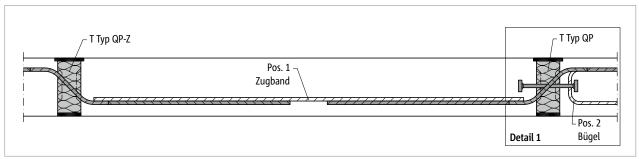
Schöck Isokorb® T Typ QP-Z, QP: Schnitt A-A; Bewehrungsanschluss Zugband
